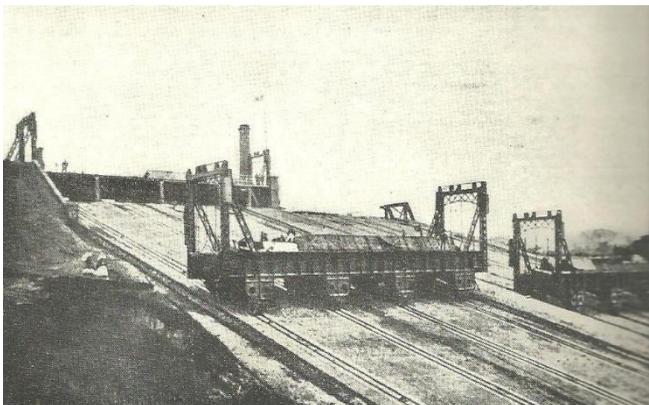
/2. Duas das poucas fotos do plano inclinado transversal de Foxton.
